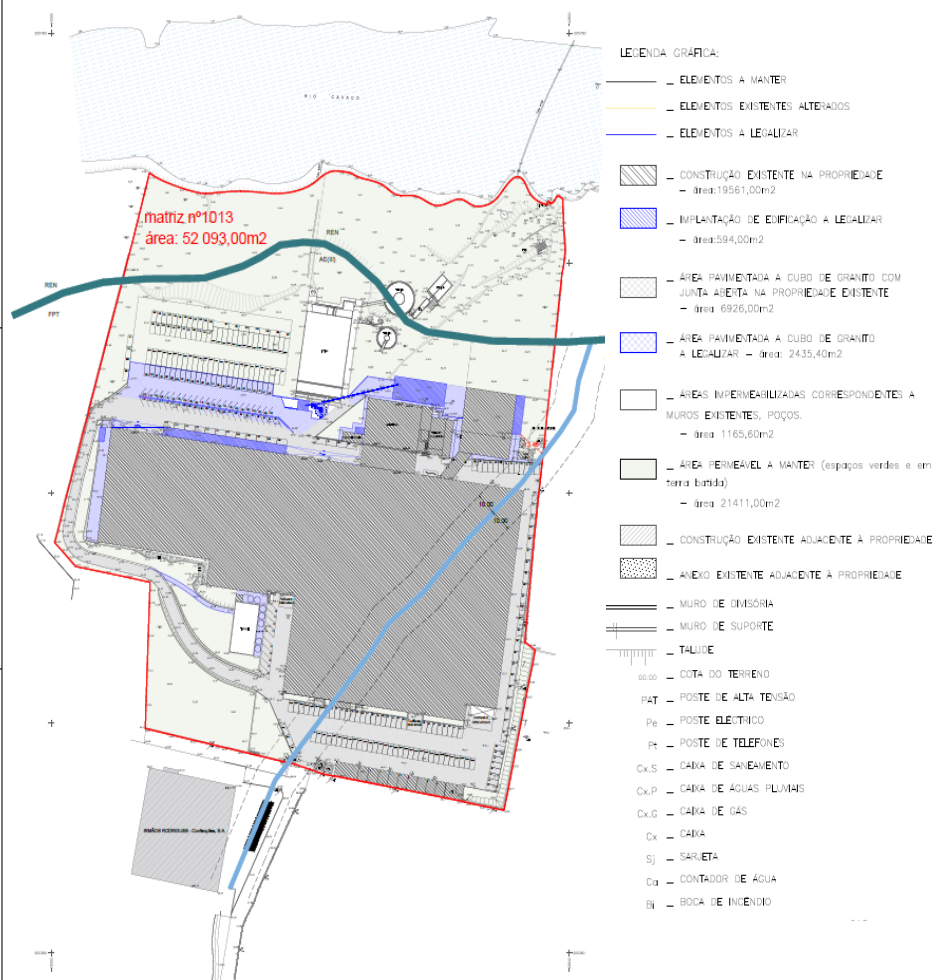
Planta de Implantação da ACATEL (Fonte: Anexo H do EIA)
